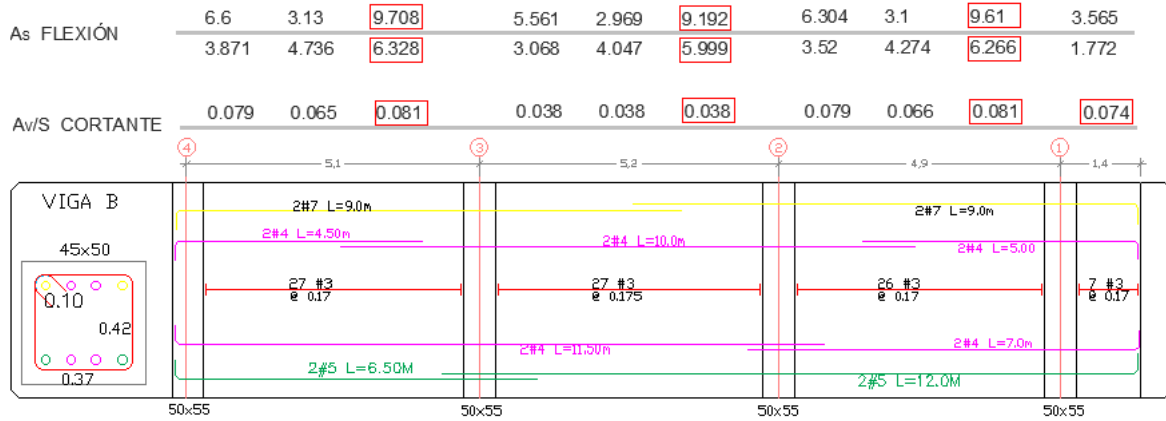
Cuantías obtenidas por esfuerzo a flexión, cortante y despiece de la viga B de la planta estructural. Fuente: elaboración propia.
